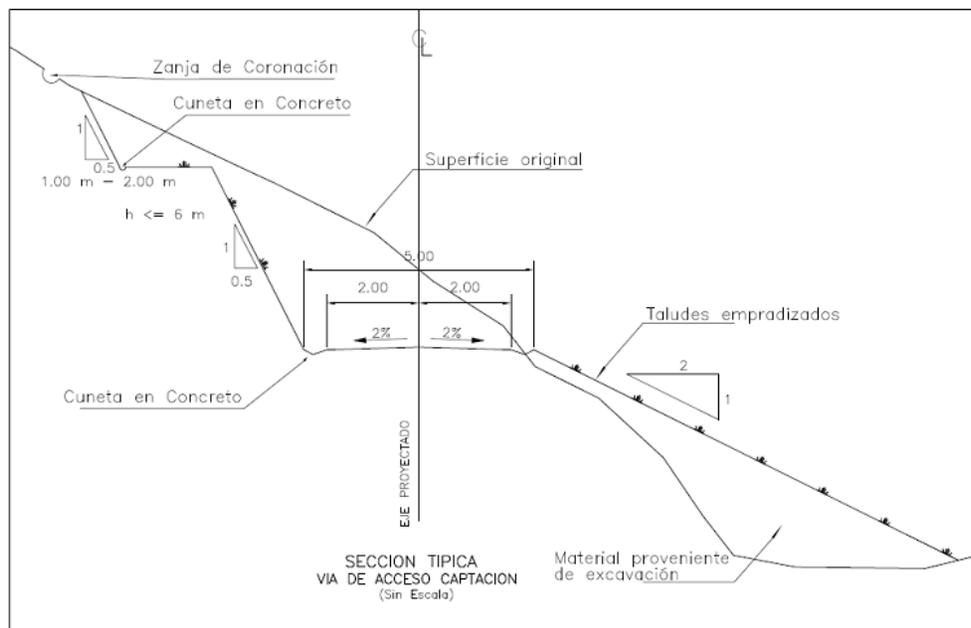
Sección transversal típica de vía para adecuación y construcción
